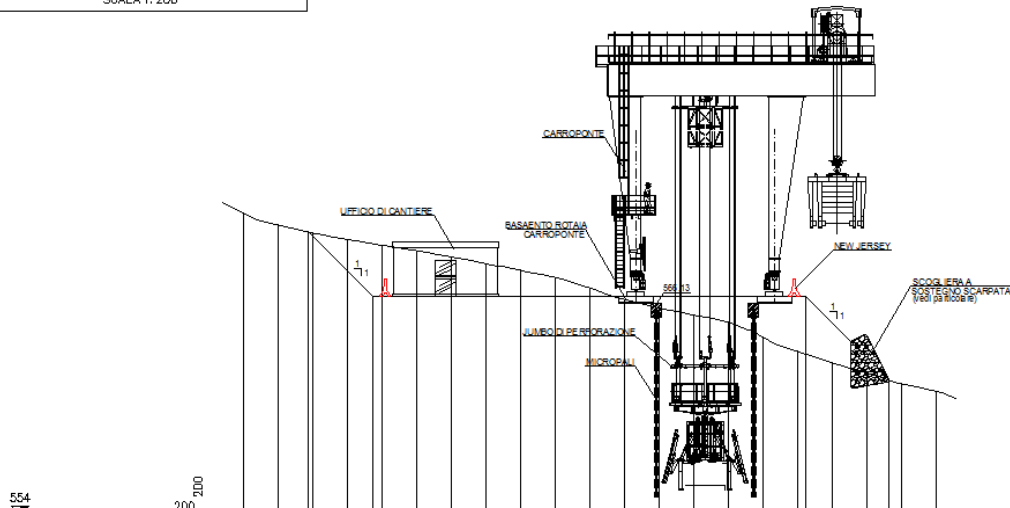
Cantiere pozzo: fase 2 – sezione in corrispondenza del pozzo e del carro ponte
